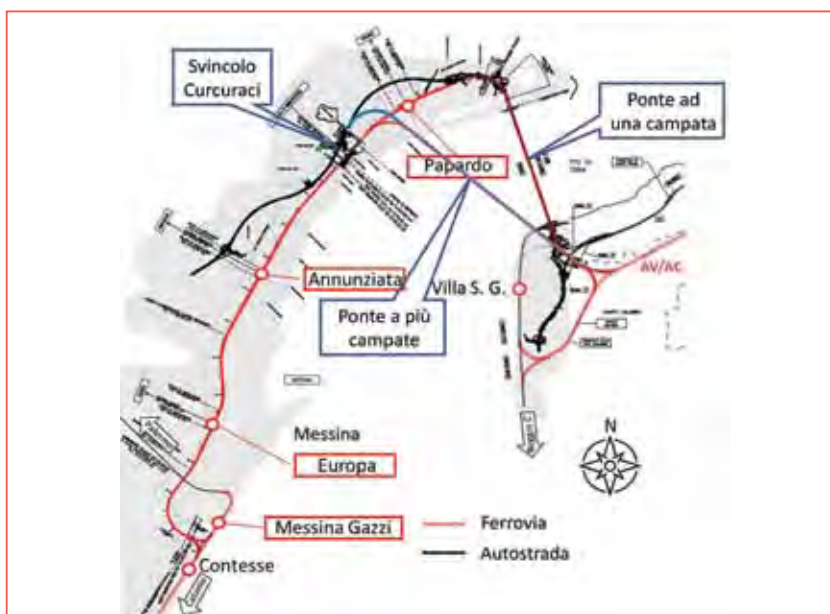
Schema planimetrico dei raccordi stradali (linee nere) e ferroviari (linee rosse) che dovrebbero essere realizzati insieme al Ponte sullo Stretto a una o a più campate [15].
